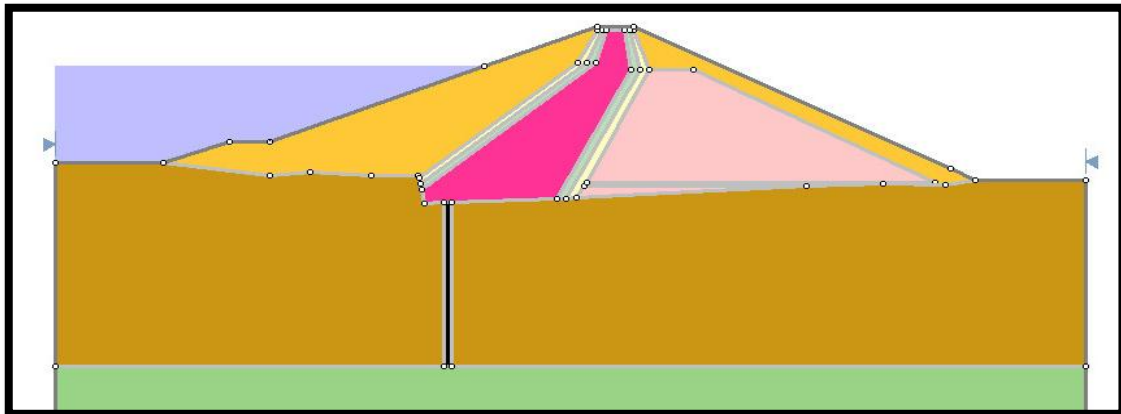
Profil Rive droite P500 du barrage AIN ZADA
